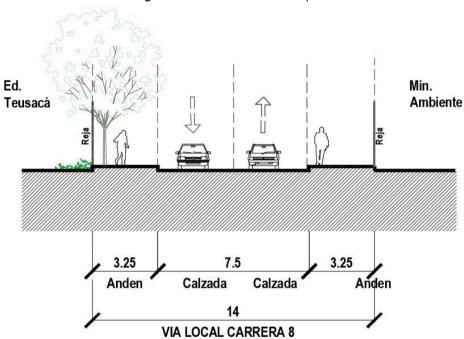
Perfil actual Carrera 8ª Tipo V-7
